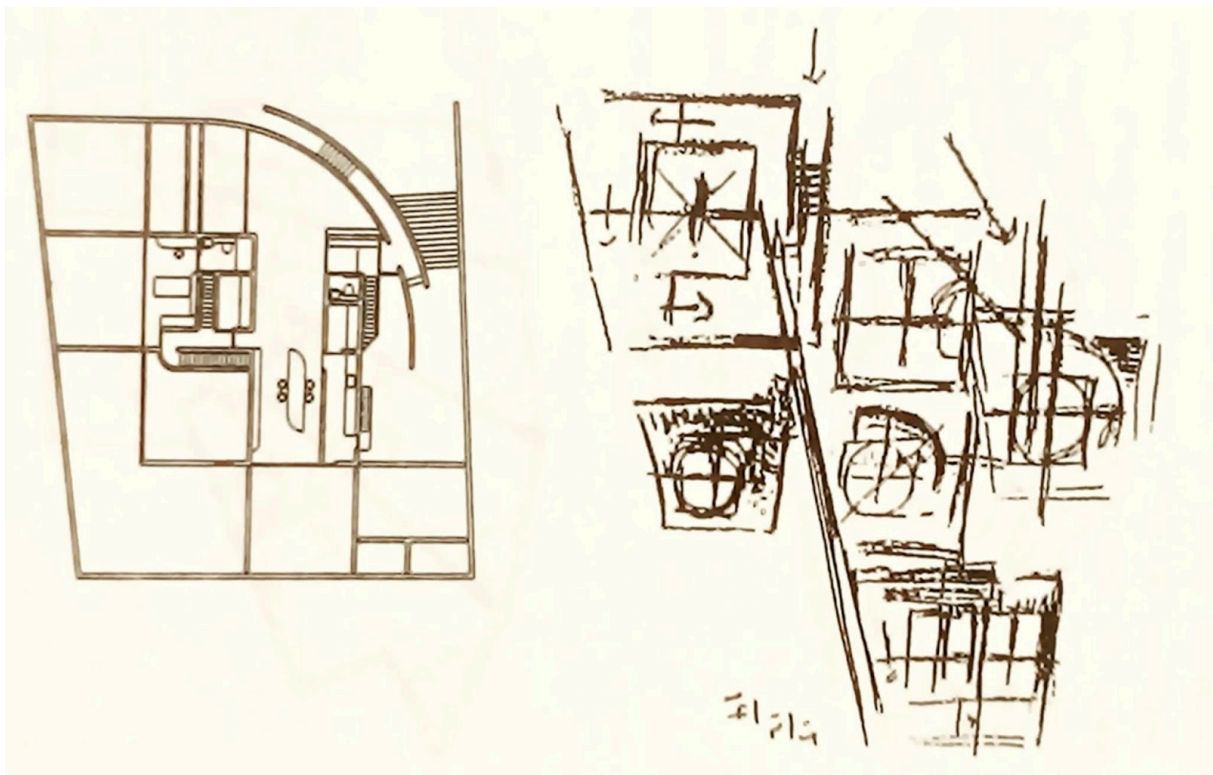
Plan et croquis de la Maison Kidosaki, 1982-1985.
